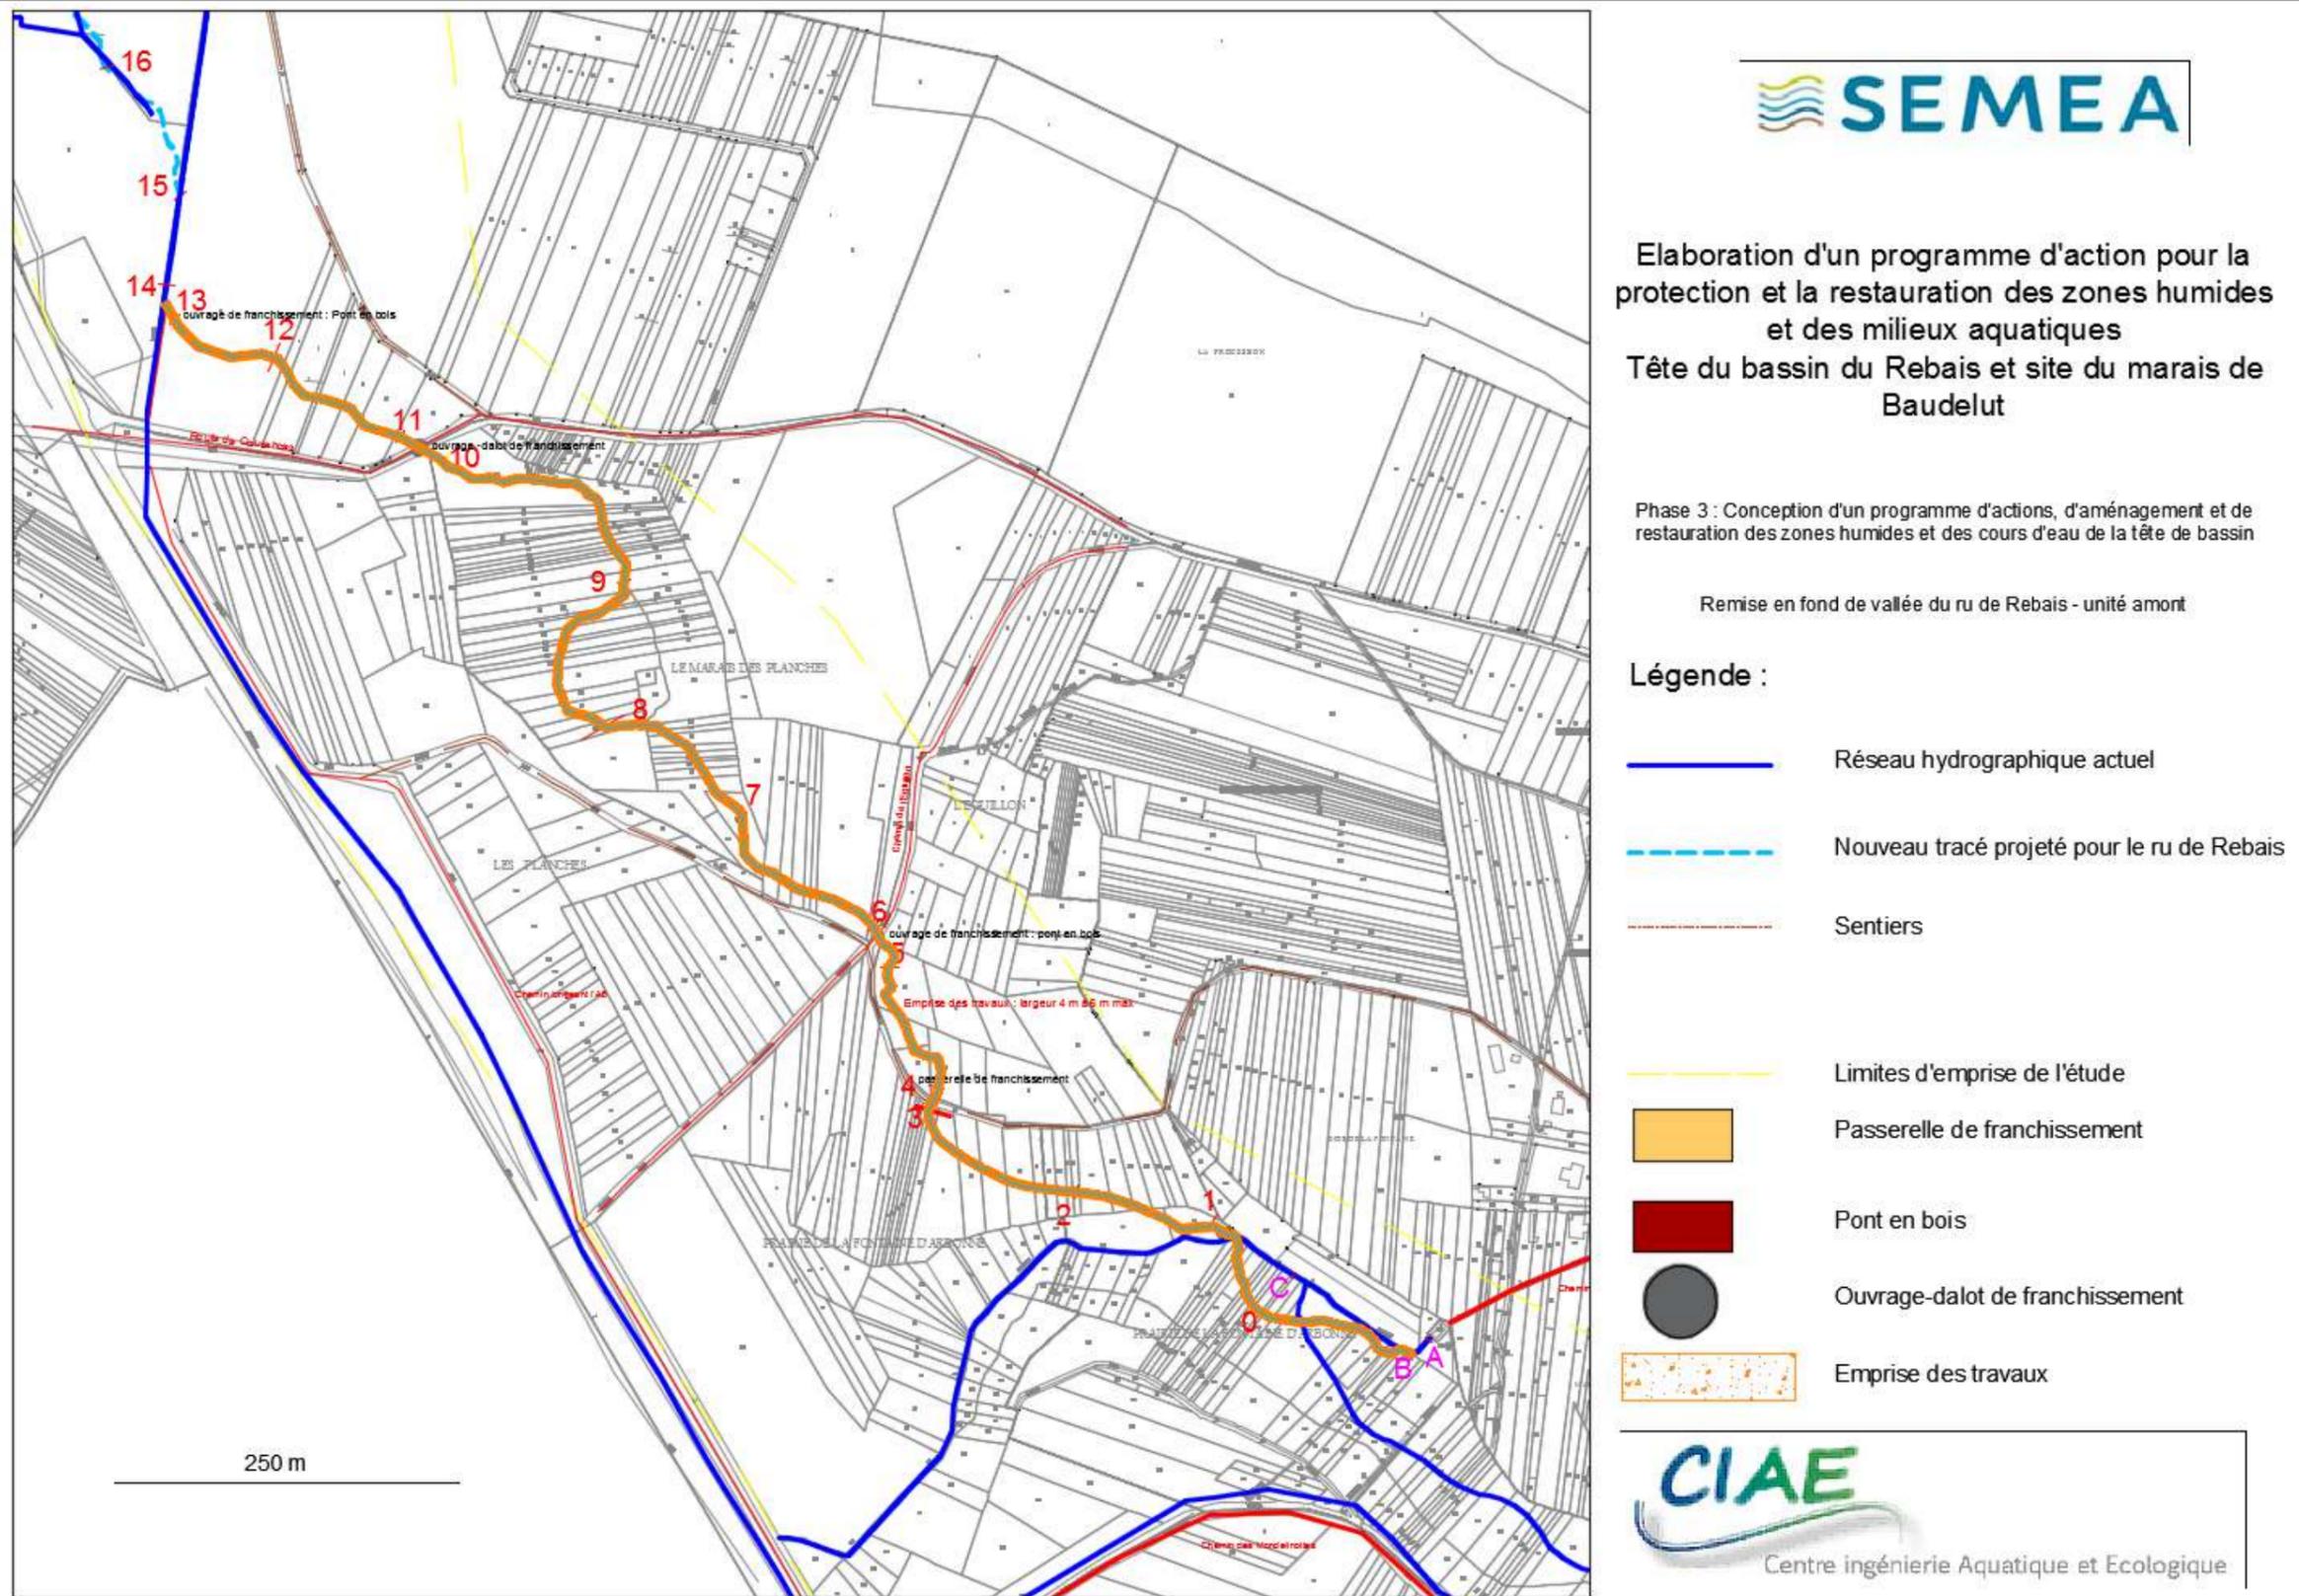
Remise en fond de vallée du ru de Rebais - plan de masse
